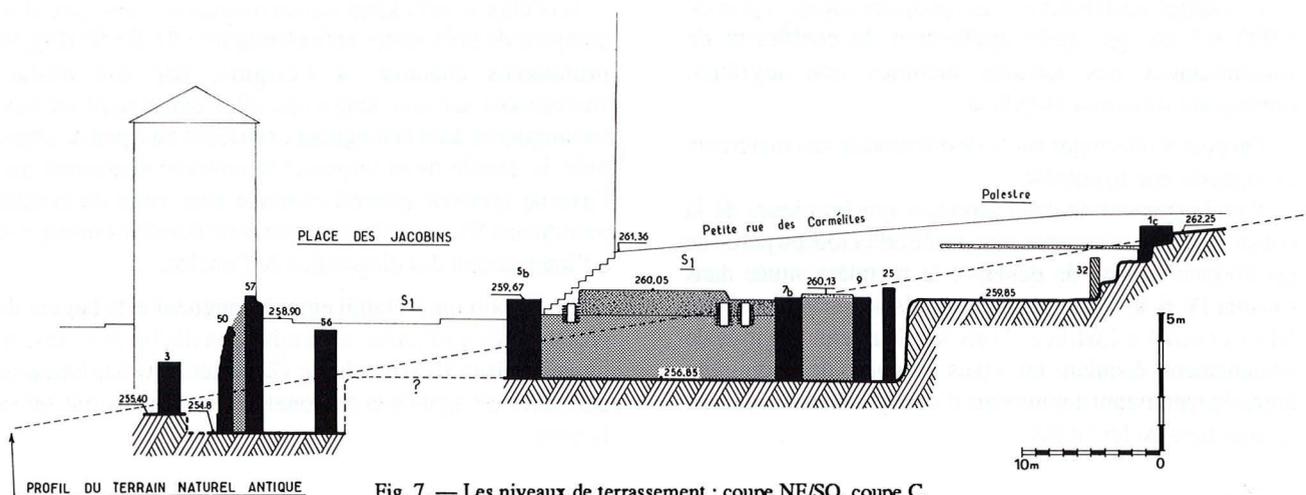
Les niveaux de terrassement : coupe NE/SO, coupe C.
